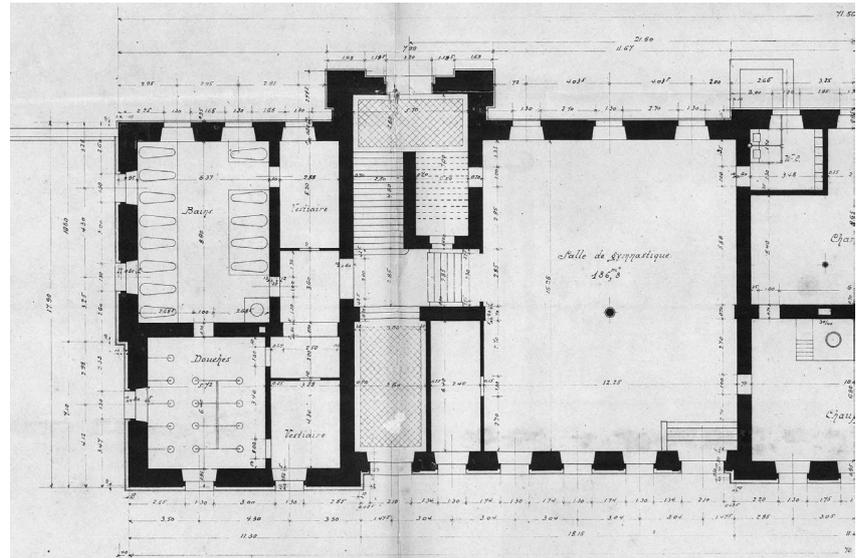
Collège de l'Ouest, plano de construcción, planta sótano. 1899. Service d'urbanisme et de l'environnement de La Chaux-de-Fonds
